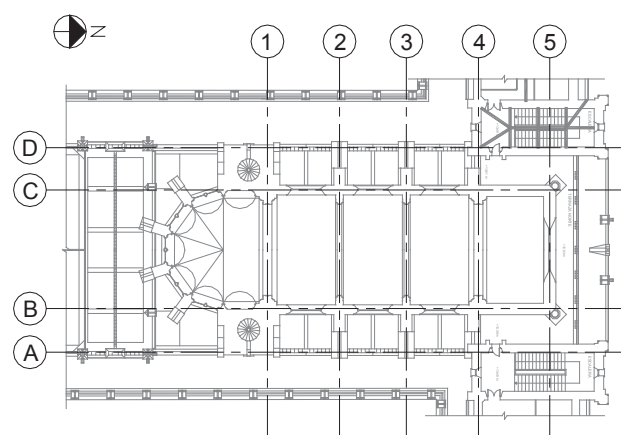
Planta de referencia con las secciones consideradas para el levantamiento de grietas.
